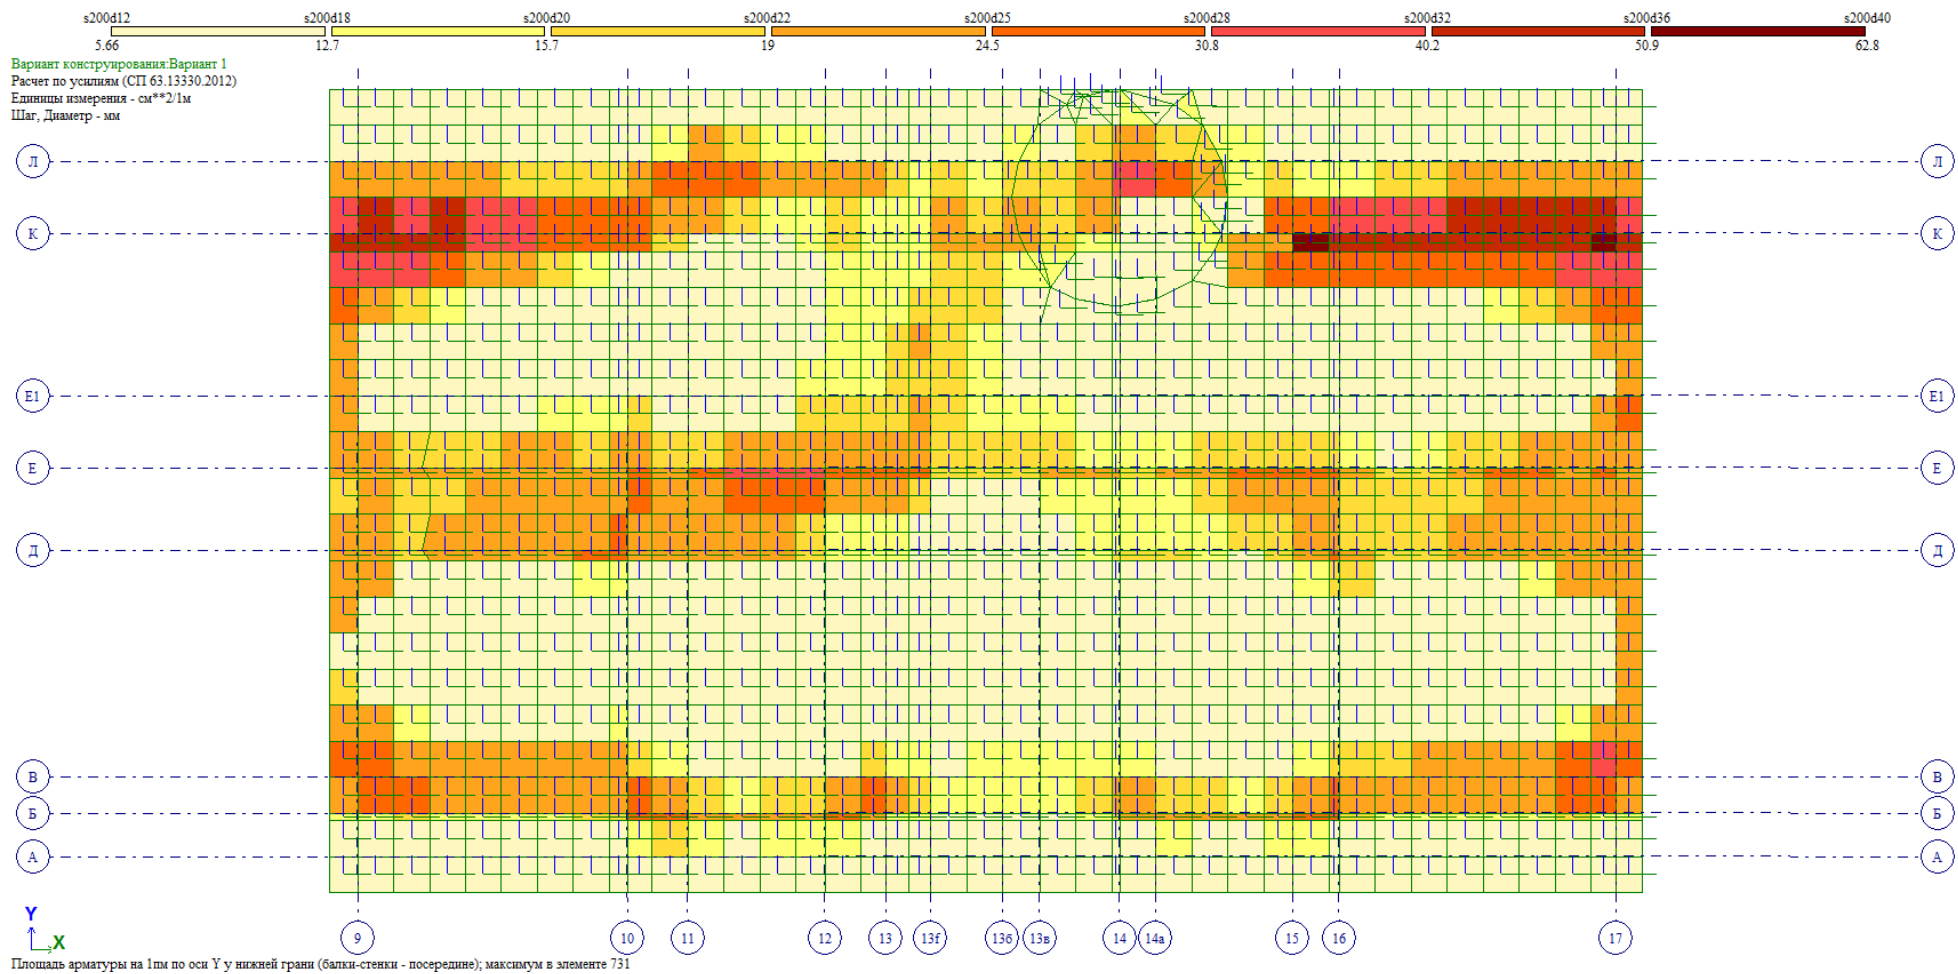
Площадь арматуры у нижней грани фундаментной плиты по оси Y (карстовая воронка расположена в осях 14/Л секции В)
